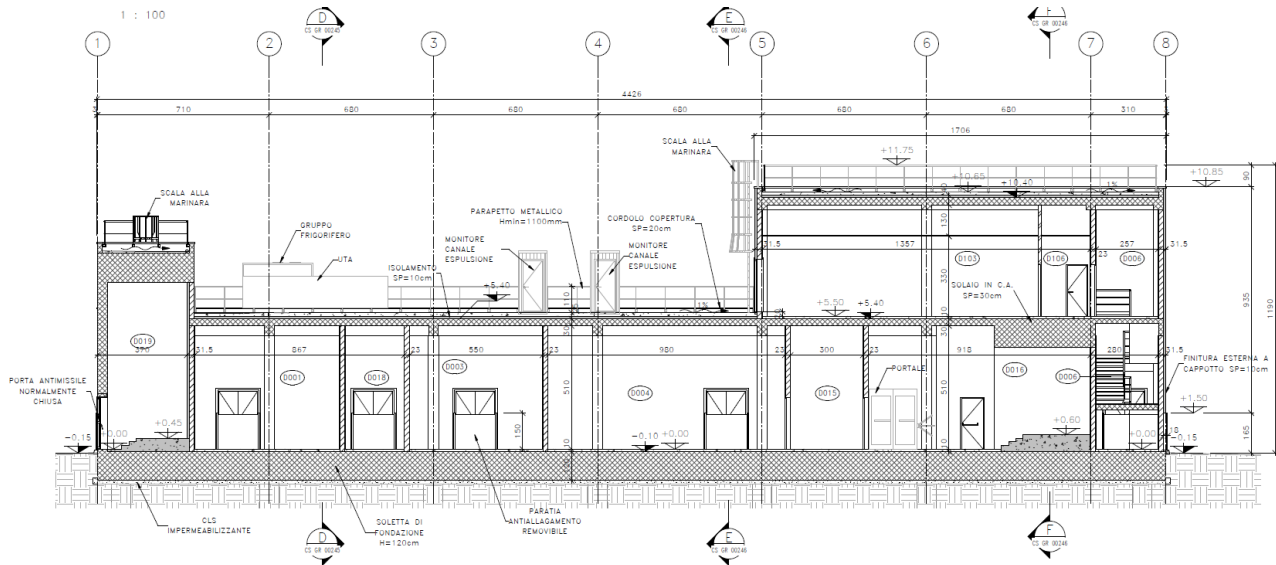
Sezione longitudinale sul Locale Servizi
